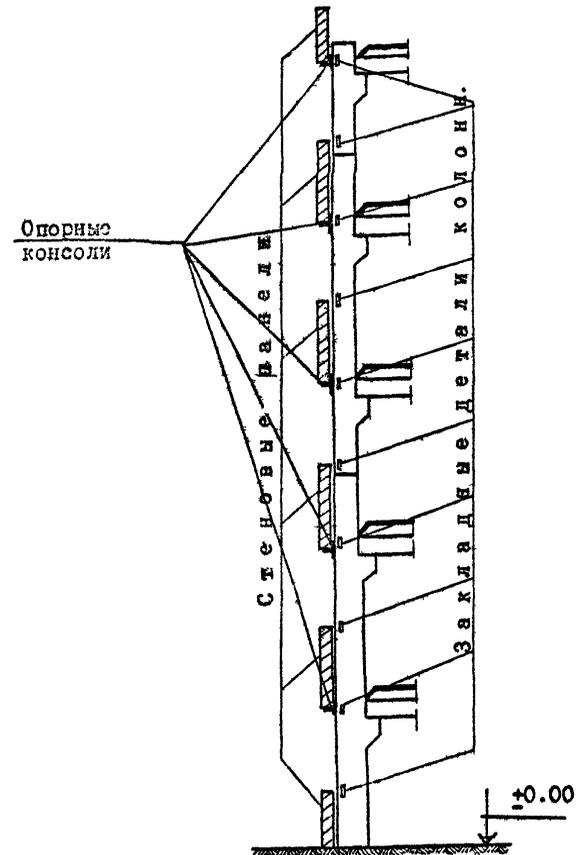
Размещение узлов крепления стеновых панелей в многоэтажном здании.
